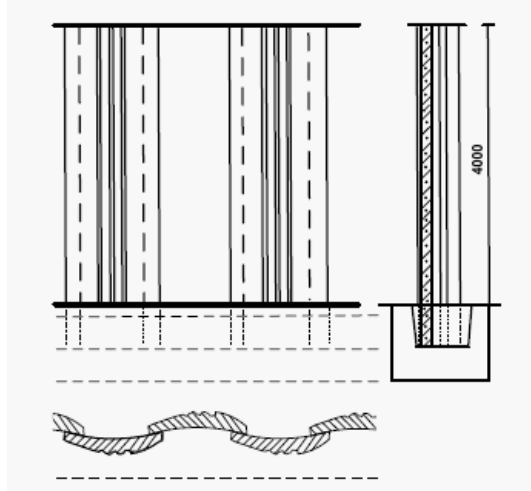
Barieră acustică din elemente de beton - vedere și secțiuni -
